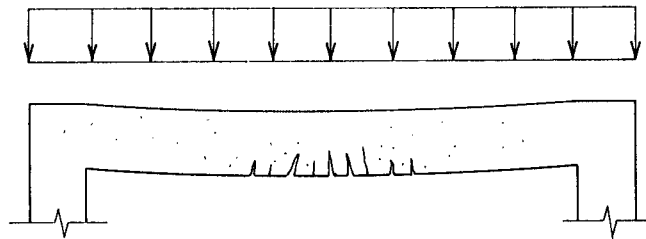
VIGA APÓS TER ATINGIDO O MOMENTO DE FISSURAÇÃO
